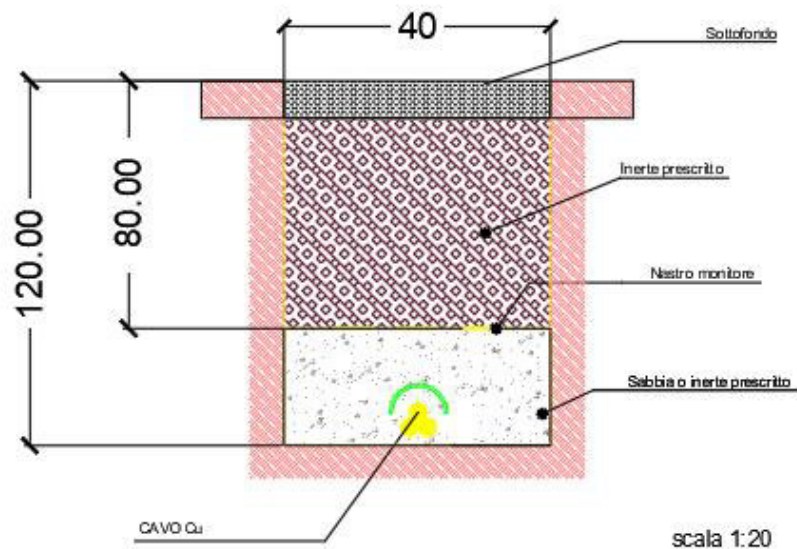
Sezione tipica cavidotto esterno su strada asfaltata (1 terna).
